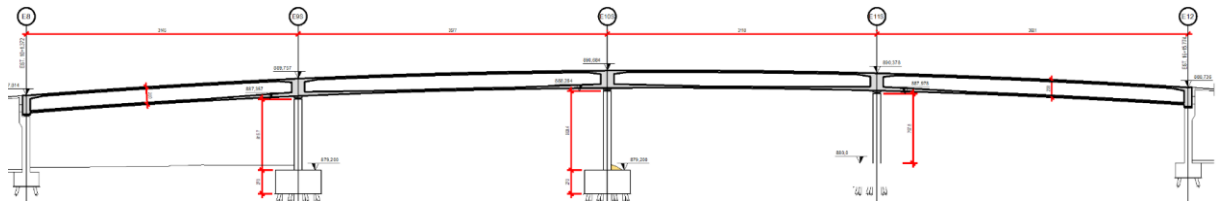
ELEVÇÃO VIADUTO (RAMO 000)
